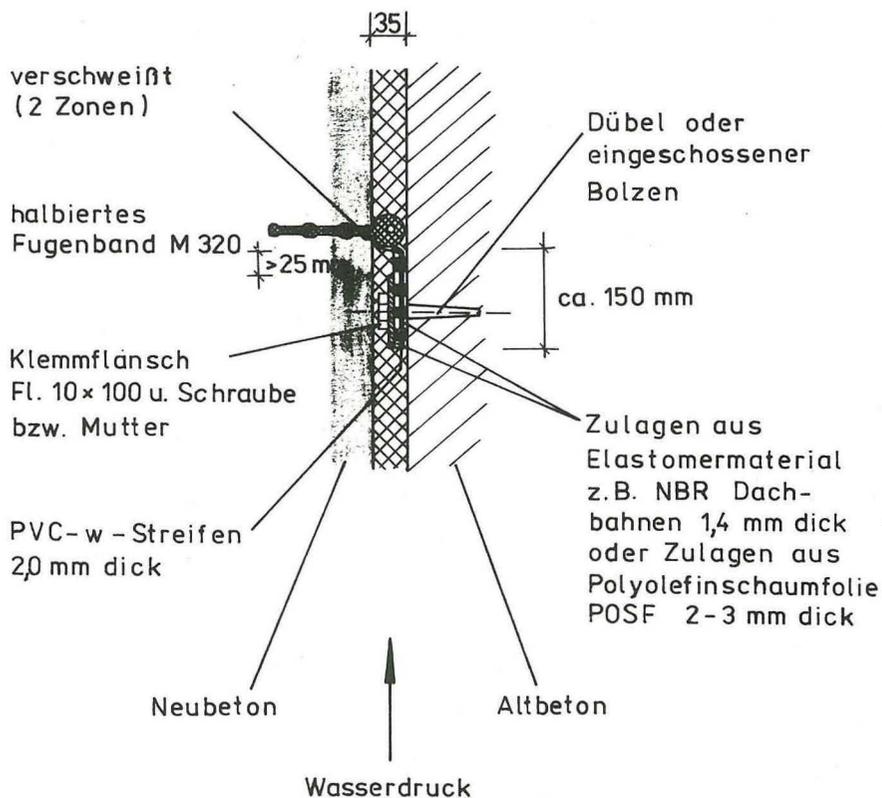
Klemmanschluß mit präpariertem Mittelfugenband
